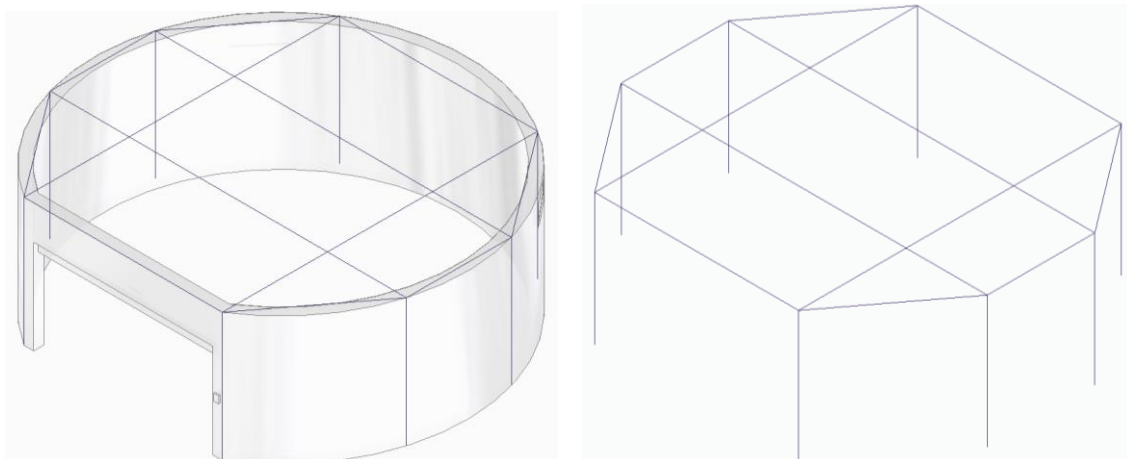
Distribución de vigas y pilares en el aparcamiento
